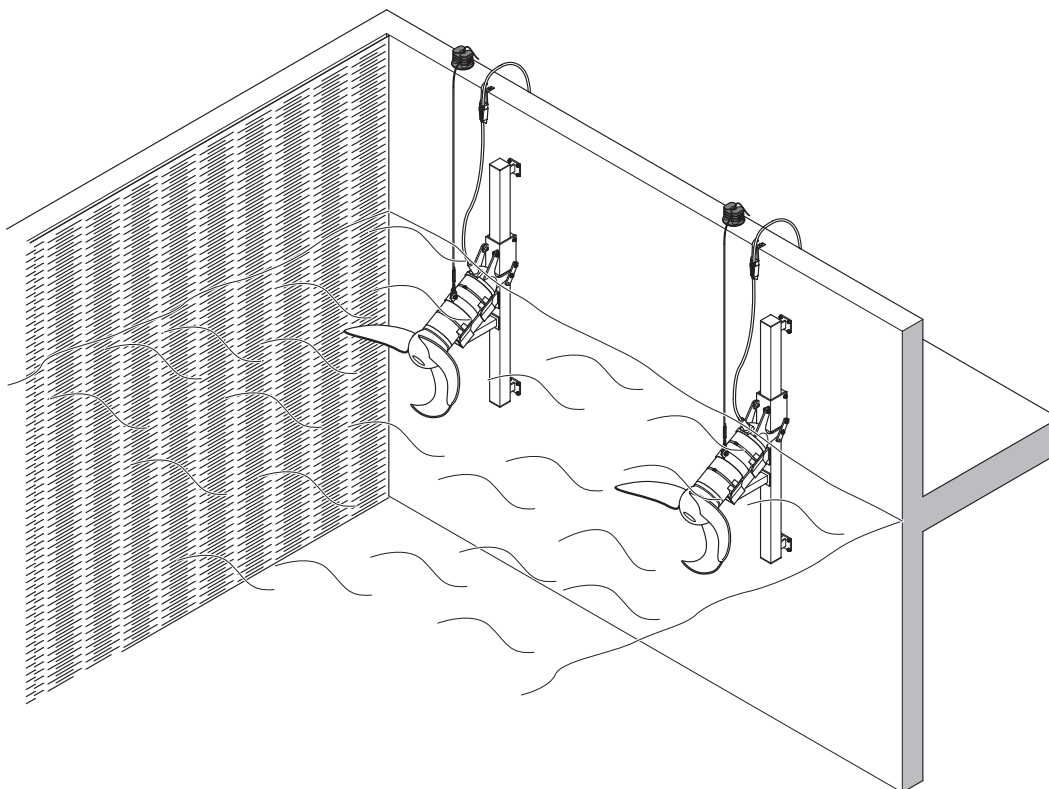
Przykład instalacji stałej jako przyspieszacz przepływu
